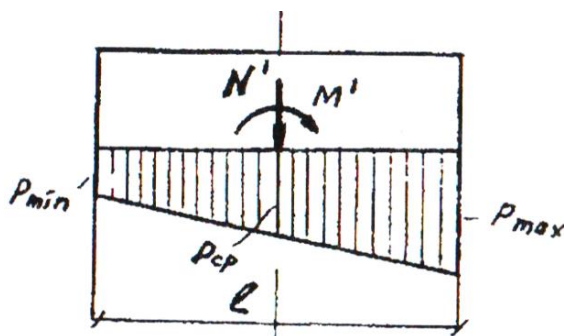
Эпюра давлений под подошвой фундамента
